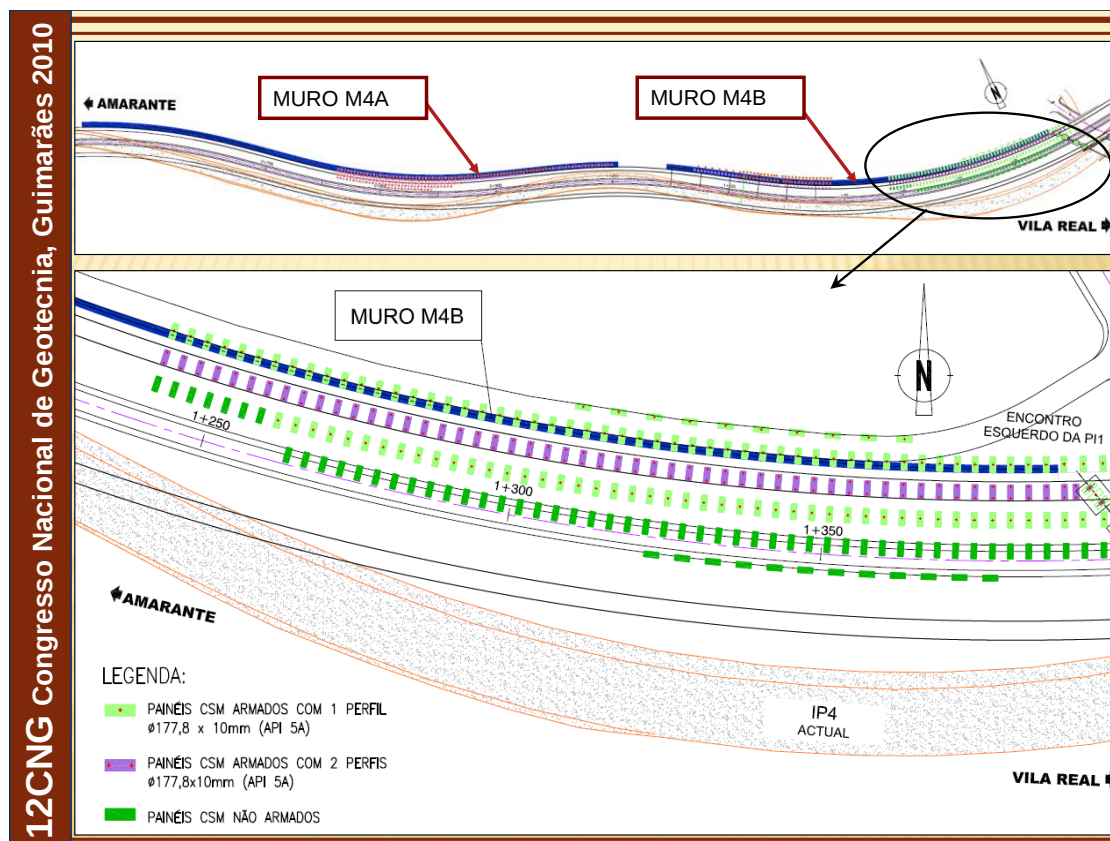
Planta de localização dos muros M4A e M4B e planta de pormenor do muro M4B na zona onde foi realizado o tratamento do terreno de fundação com painéis CSM
